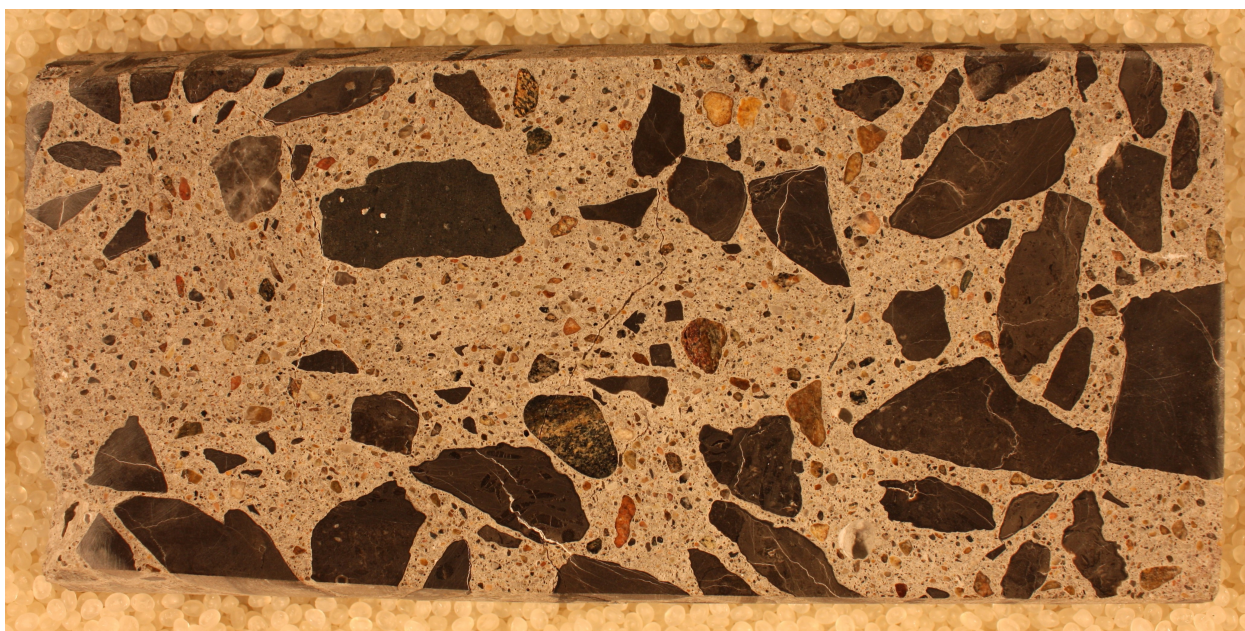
Section polie - Elément D7-38-2-C4-S2
